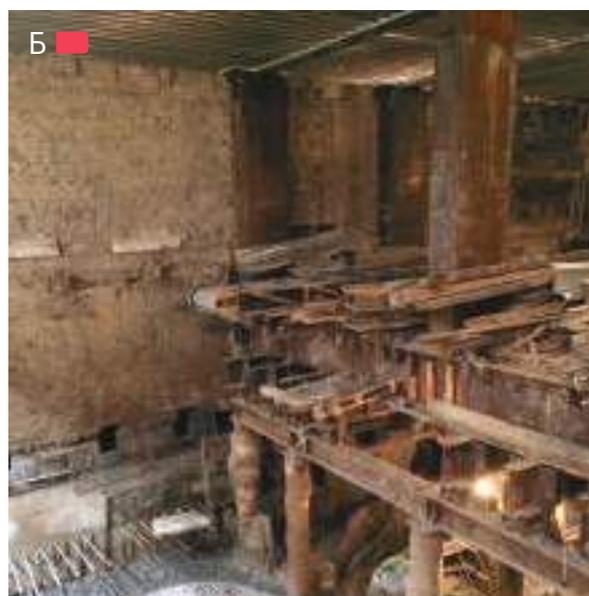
Освоение подземного пространства при размещении свай вдоль существующих фундаментов средних стен с временным перехватом металлическими траверсами, г. Киев 2014 г.
